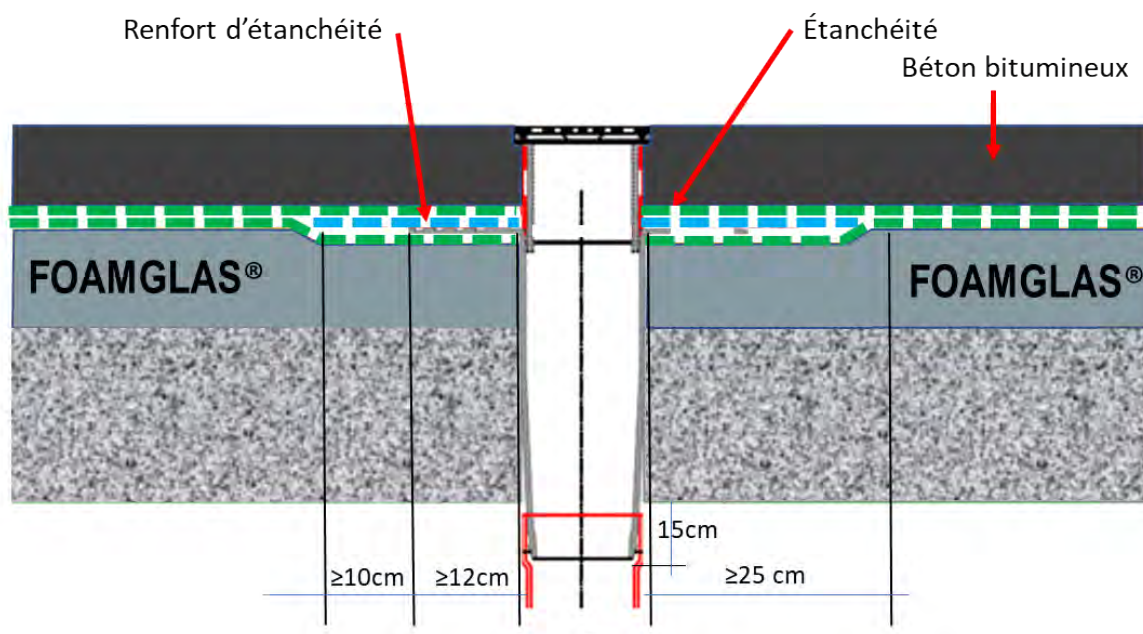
Traitement d'entrée eau pluviale en terrasse accessible aux piétons
